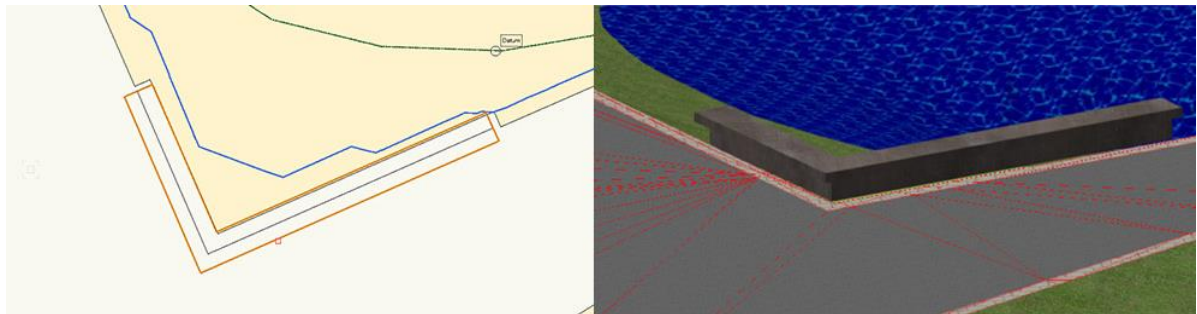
Modelação 3D - Murete Banco - Vista 2D e 3D
